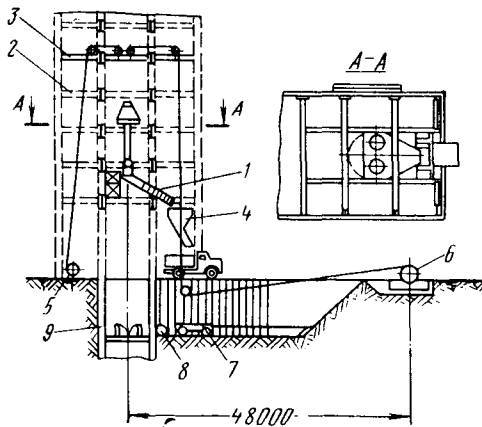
Схема совмещения работ по строительству башенного копра и армировке ствола шахты «Гигант-Глубокая»:
